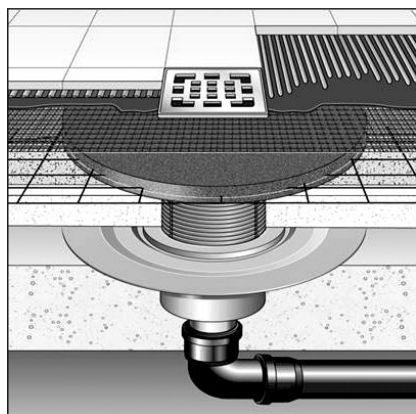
Exemplo geral de montagem - segundo nível de vedação com flange de betão polímero
